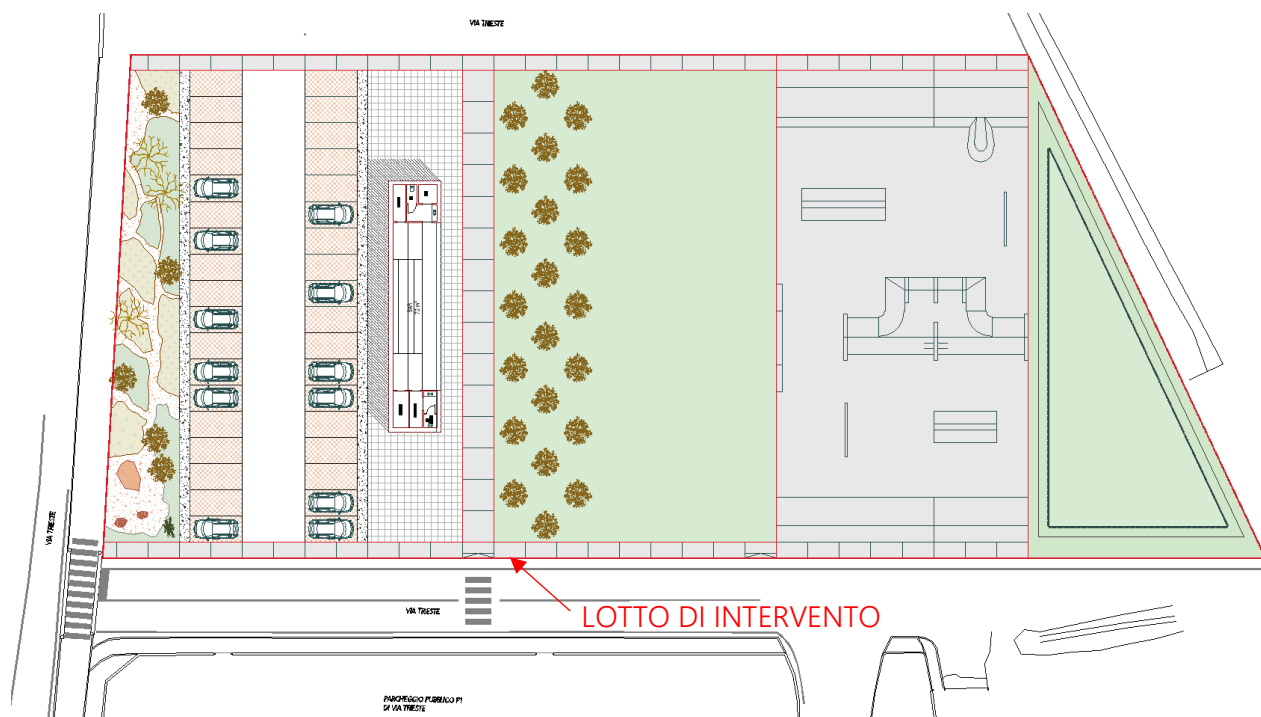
Stato di progetto definizione della permeabilità delle aree
